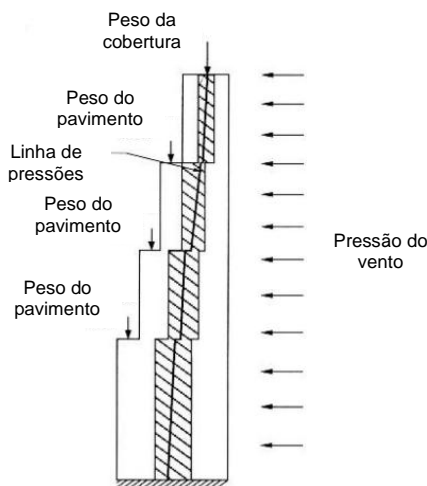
Alvenaria estrutural: ações sobre uma parede exterior (peso próprio, sobrecarga e vento) e respetiva linha de pressões. [6]
